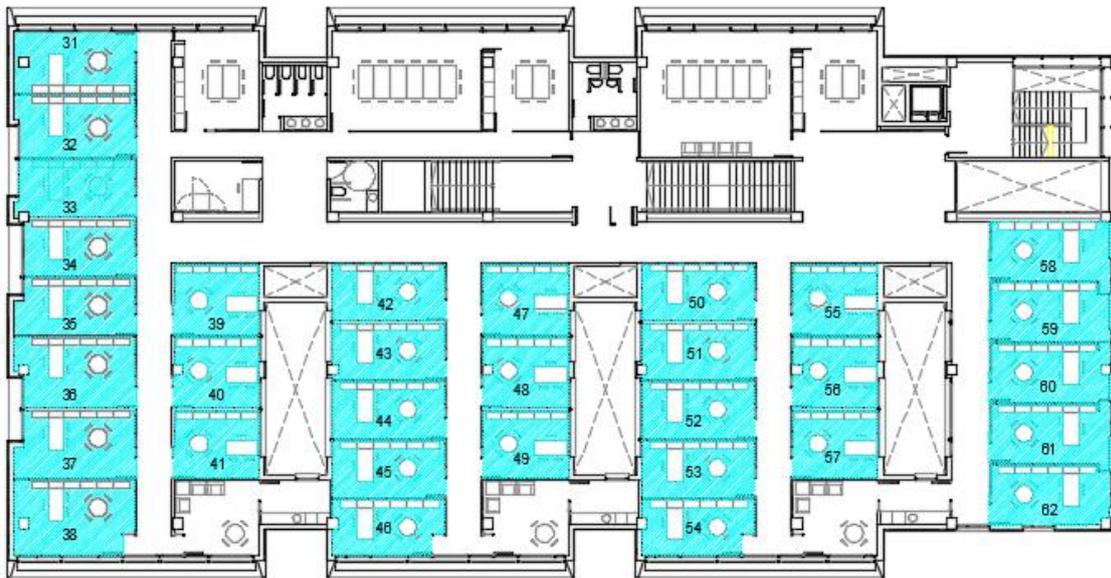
Situación Despachos en Planta Segunda. Figura extraída del plano 54.
